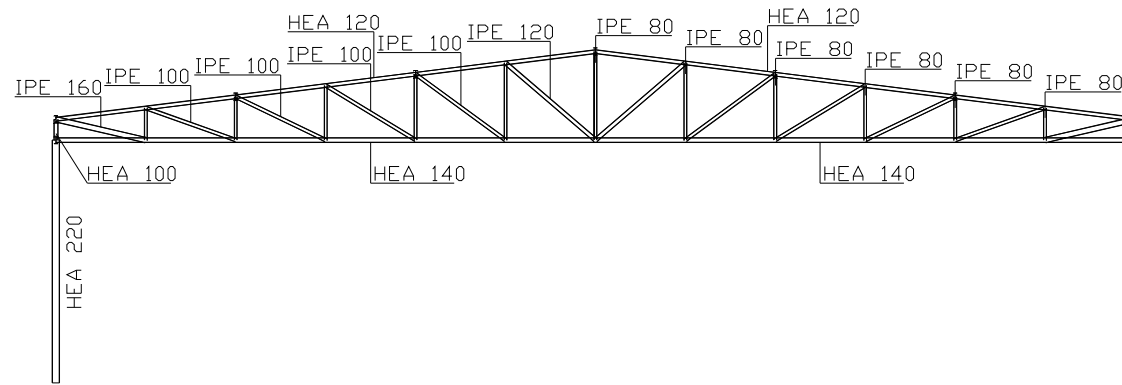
Pórtico com pilar de alma cheia, viga em treliça, vão de 30.00m, pilar em perfil com secção transversal HEA, viga em perfil com secção transversal HEA/IPE.
